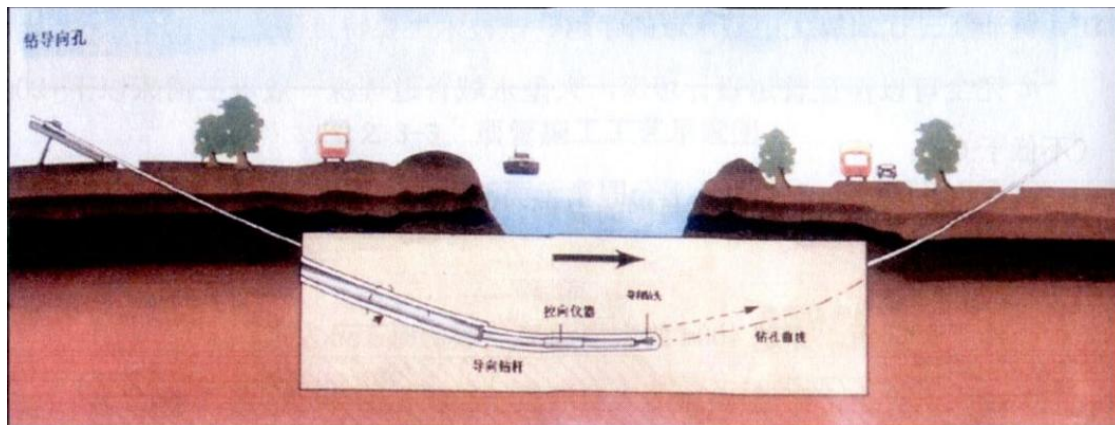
定向钻穿越施工钻导向孔过程断面示意图
